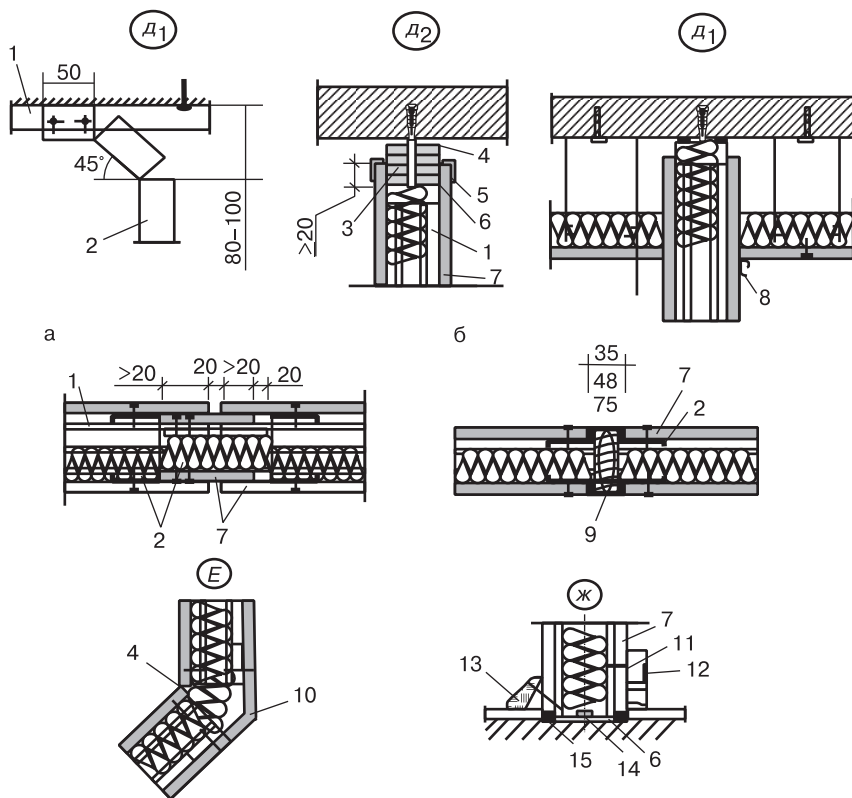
Конструктивные решения узлов перегородки из гипсокартонных листов: 1 — дюбель; 2 — лента уплотнительная (герметик); 3 — обшивка из ГКЛ; 4 — минераловатная плита; 5 — профиль ПС; 6 — лента разделительная; 7 — самонарезающий шуруп; 8 — профиль ПН; 9 — шпатлевка; 10 — профиль ПУ
